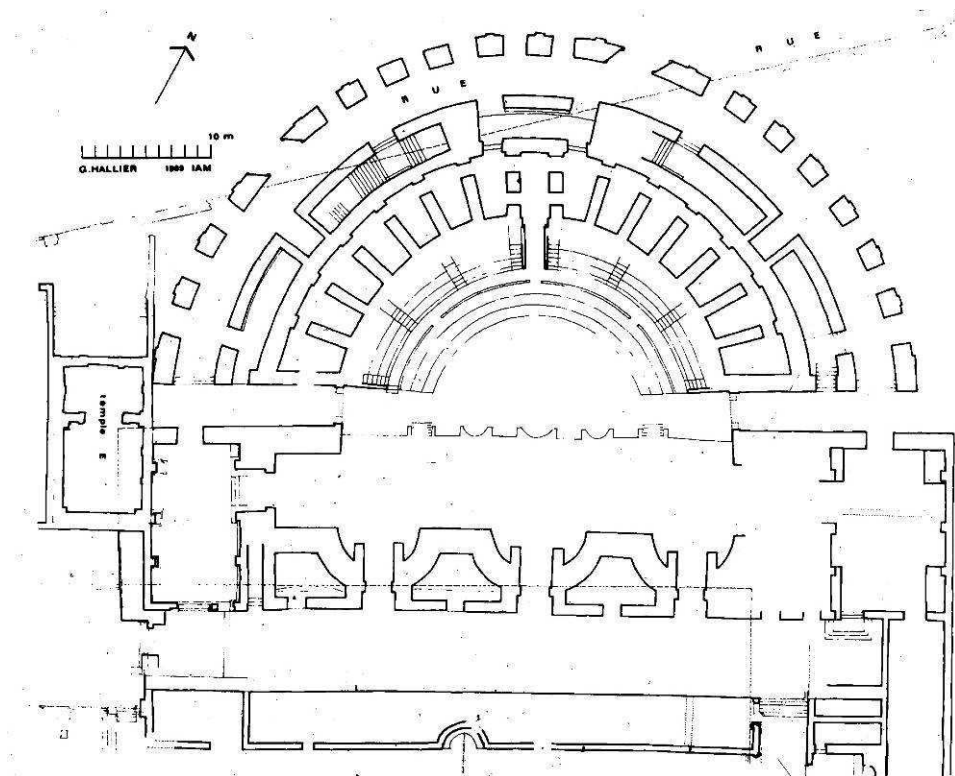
plan du théâtre relevé par Hallier dans Beschouch et alii (1977).
